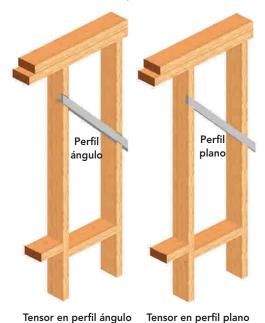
b: Ejemplos de colocación de arriostramientos en perfiles de acero (perfil ángulo y barra plana).
